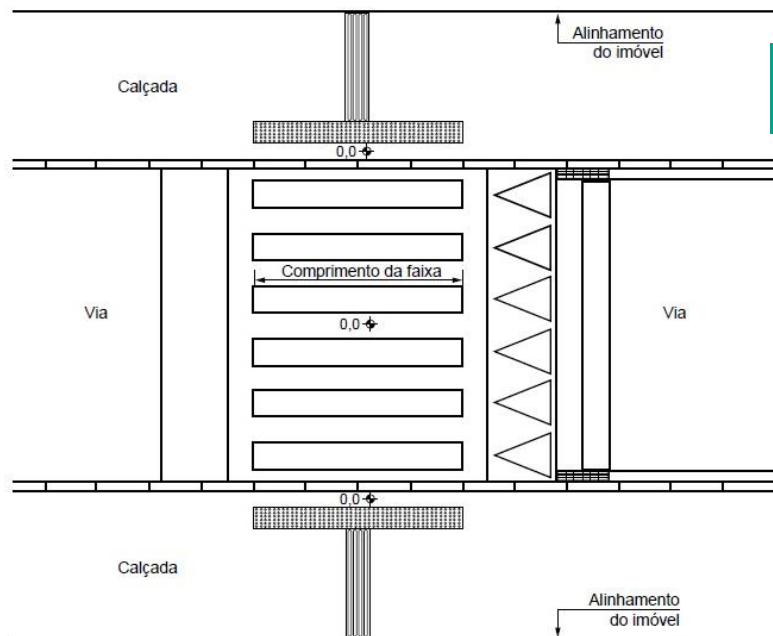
Faixa elevada para travessia – Exemplo – Vista superior
